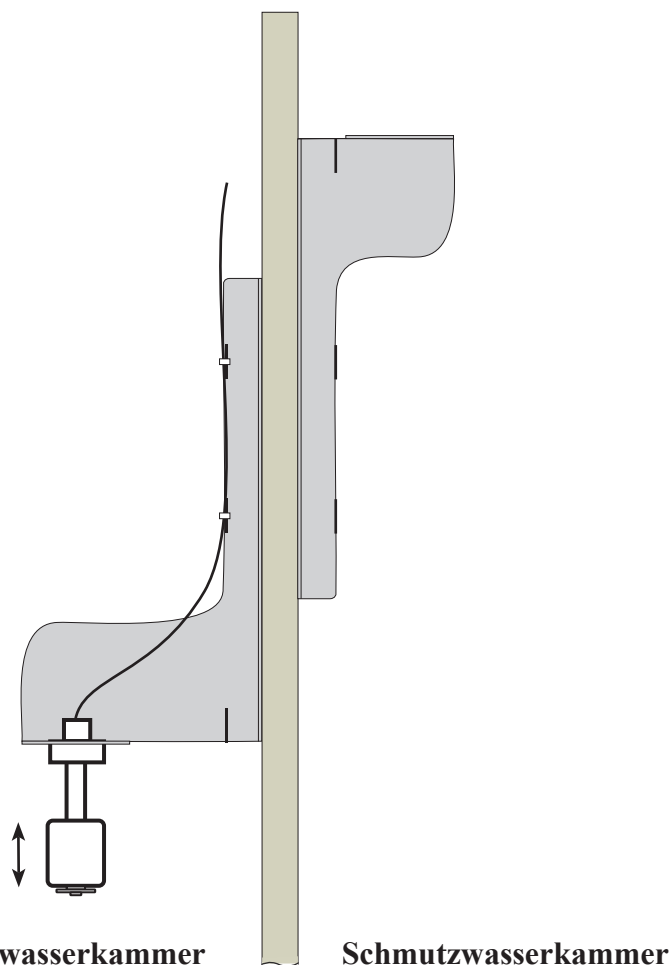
Anordnung des Sensors in der Schwerkraftprinzip-Ausführung
